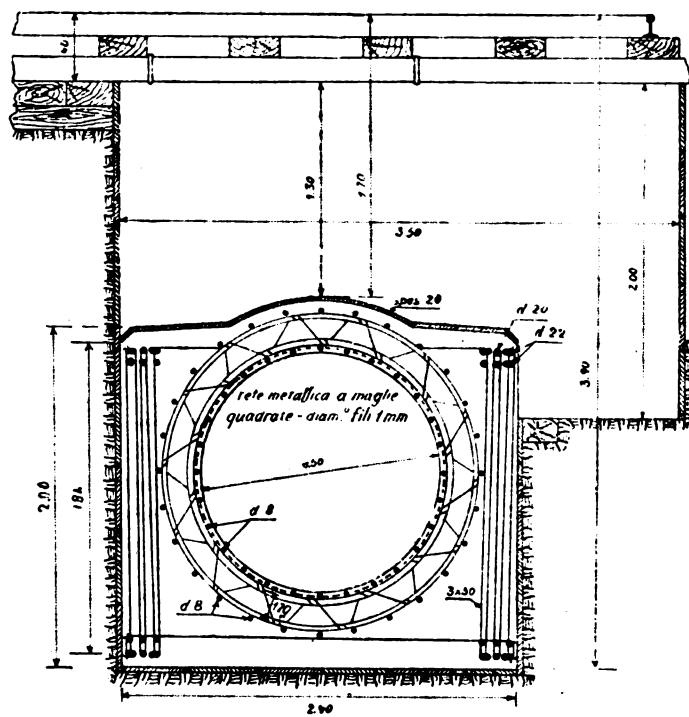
Sifone in cemento armato. - Sezione trasversale.
